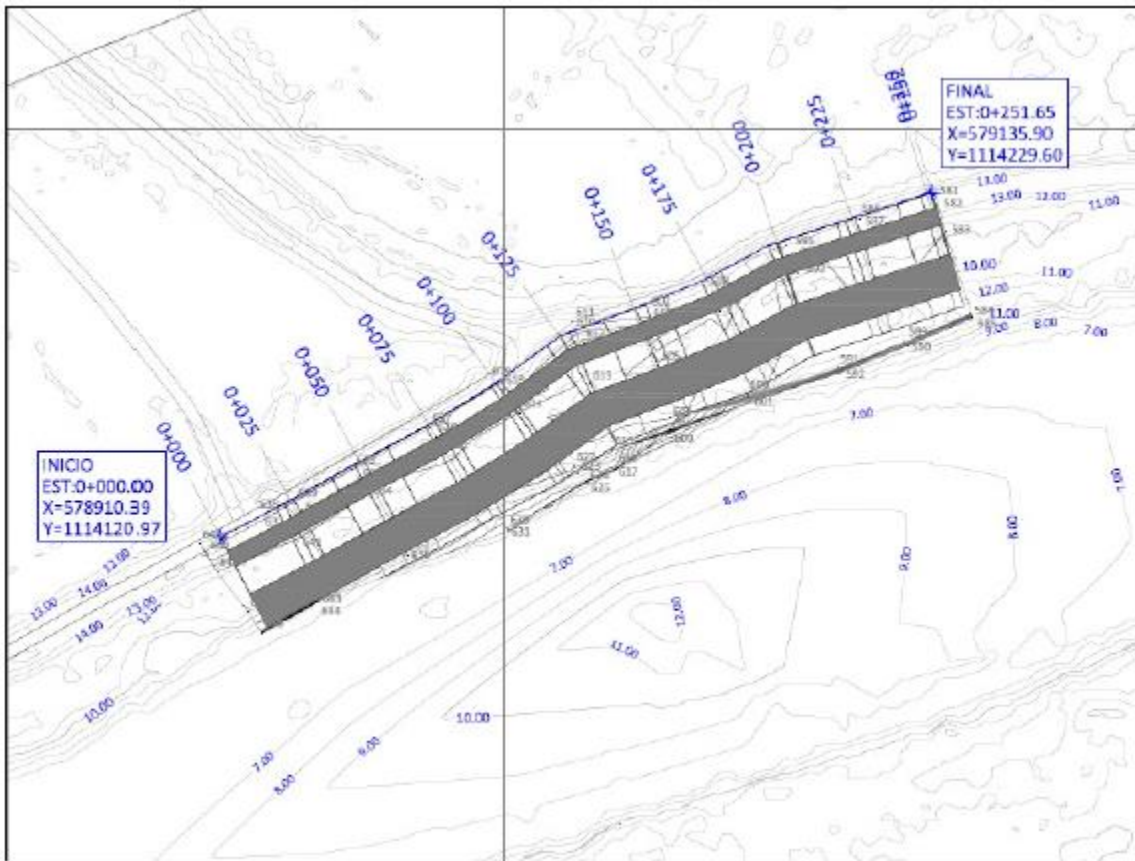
Vista en planta de las obras de protección en Zona B. Elaborado por Grupo Acón y modificado por CORBANA, 2019.
